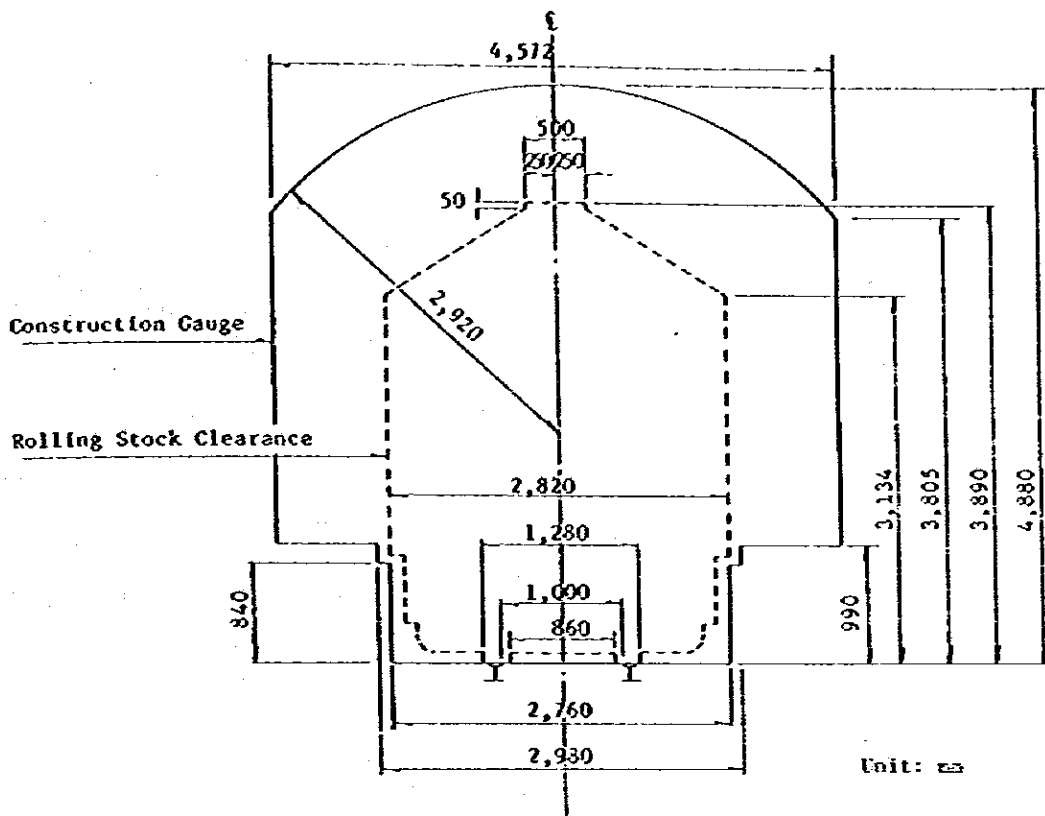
Construction Gauge and Rolling Stock Clearance
